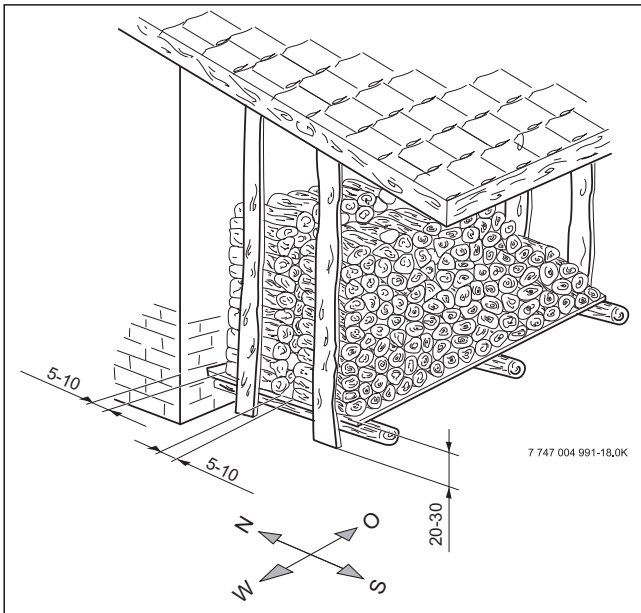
Brennstofflagerung außerhalb von Gebäuden
